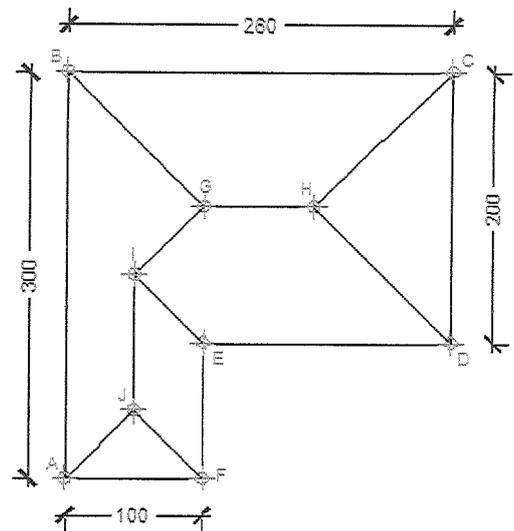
Edição de objeto no AutoCAD® (Antes da edição)
